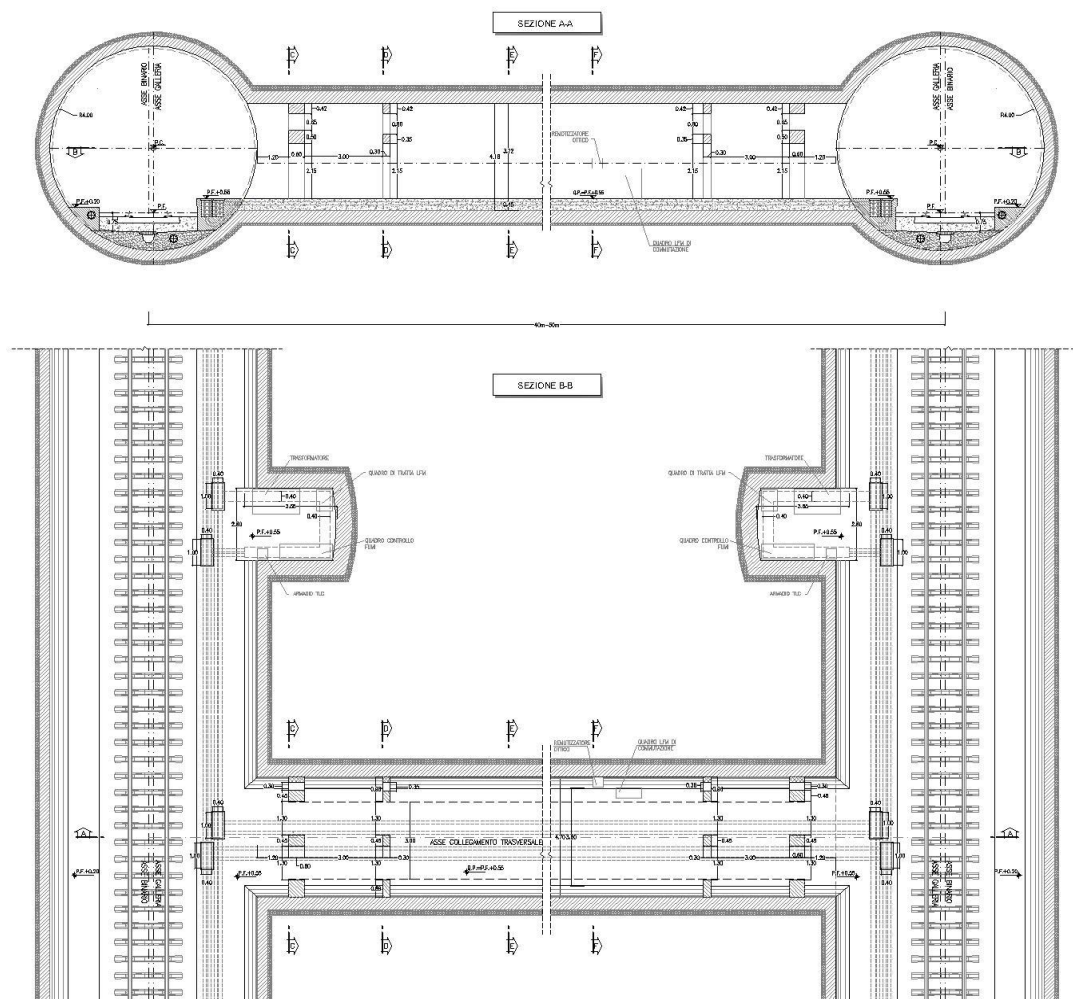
Planimetria e profilo longitudinale by-pass di esodo
